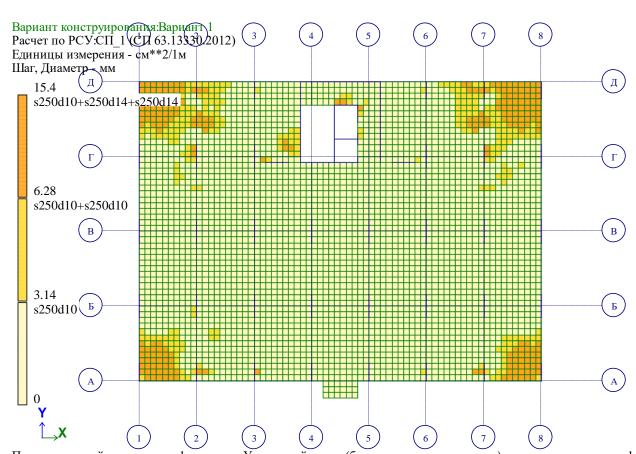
Расчетное армирование фундаментной плиты поперечной арматурой.
